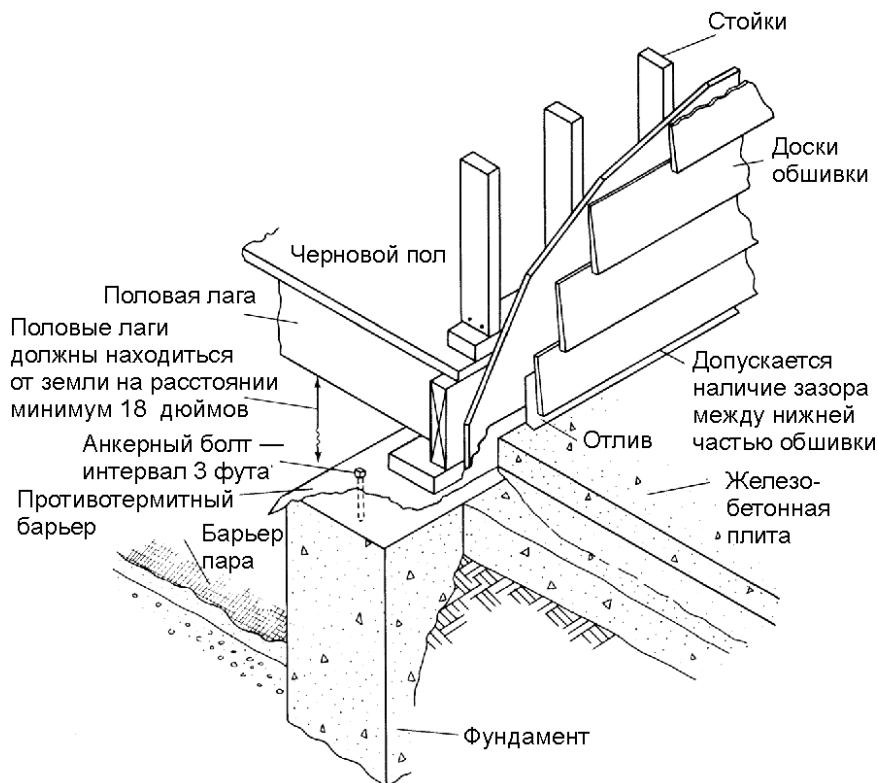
Противотермитный металлический барьер защищает деревянные элементы, примыкающие к фундаменту (Forest Products Laboratory)
